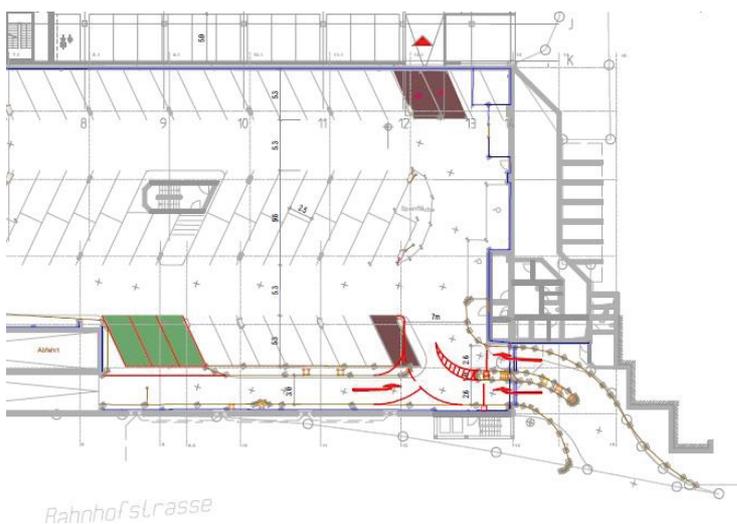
Umbau Einfahrt Bahnhofsgarage
